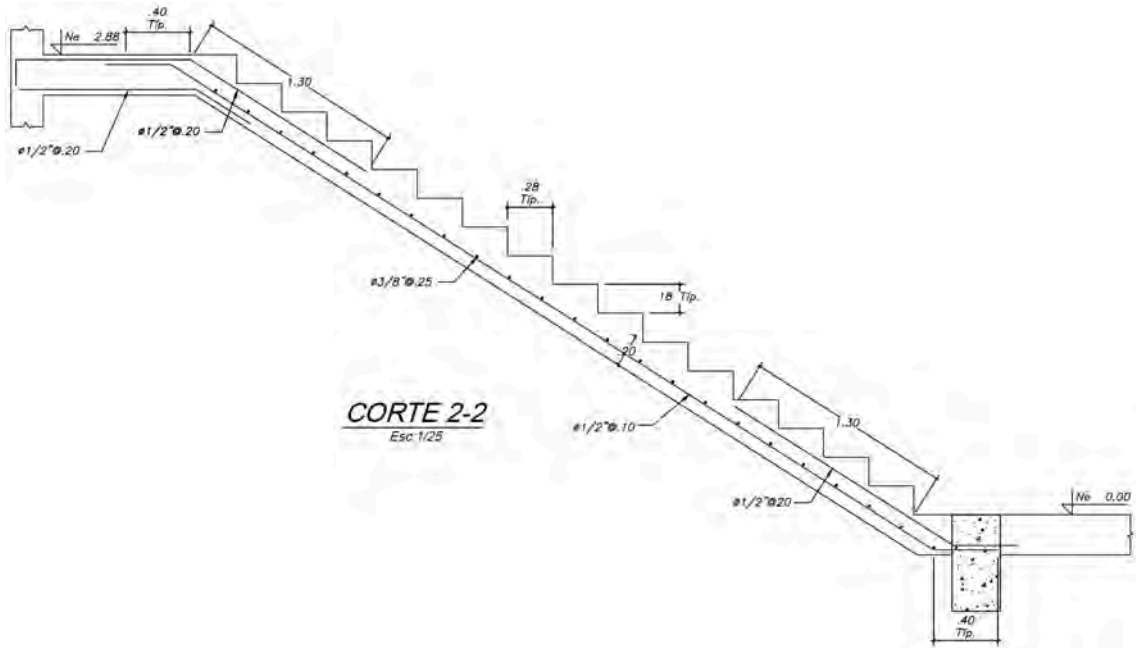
Elevación del Corte 2-2 de la Escalera
